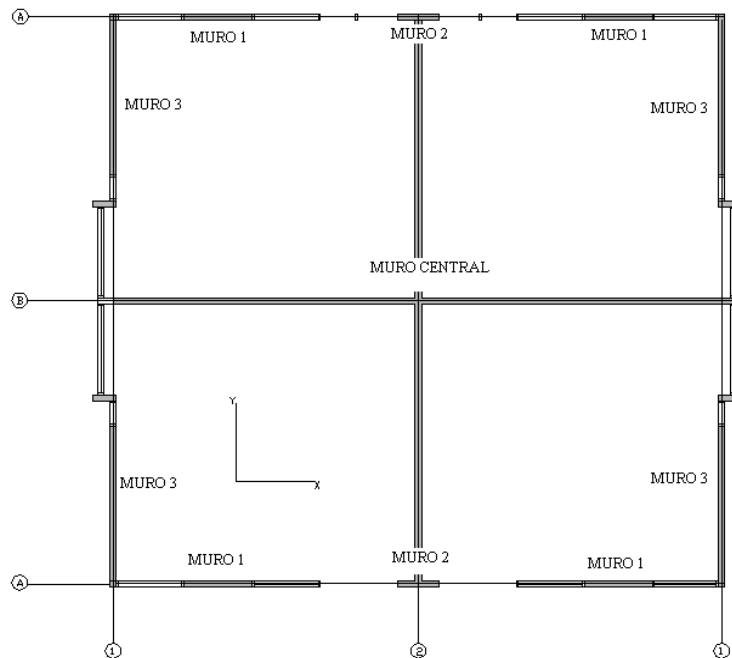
1. Planta Tipo del edificio de 4 pisos
